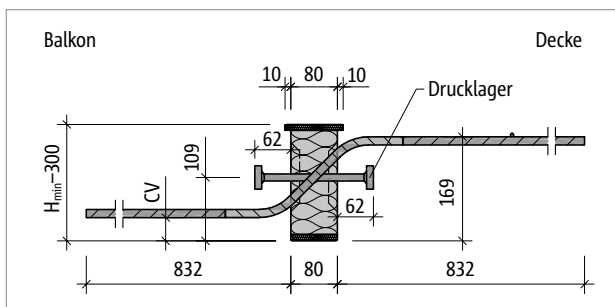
Schöck Isokorb® T Typ QP-V10: Produktschnitt
